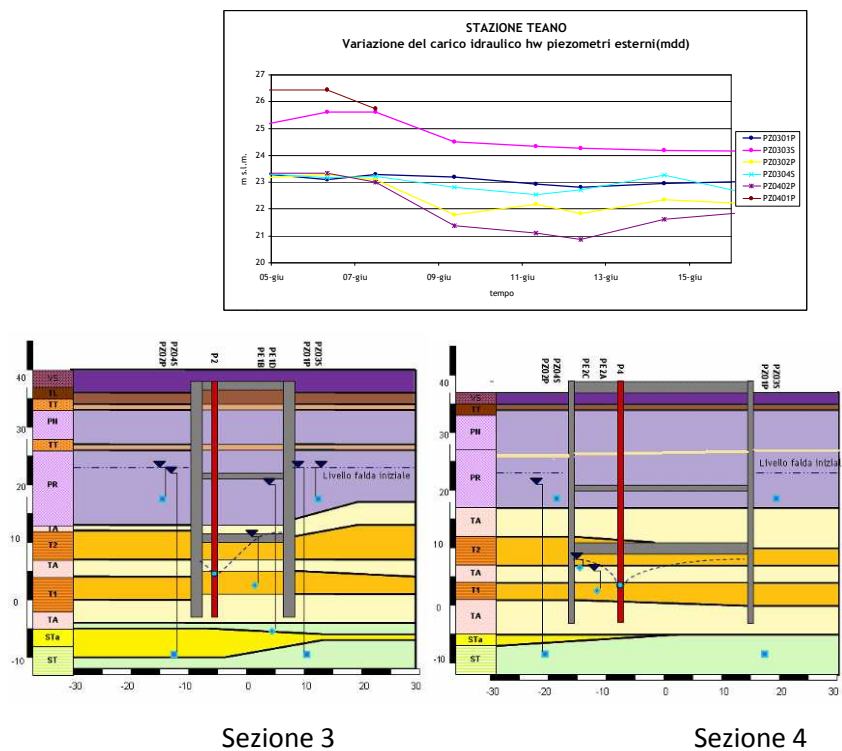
Stazione Teano: manufatto di diramazione - Letture dei piezometri esterni – Sezione trasversale
